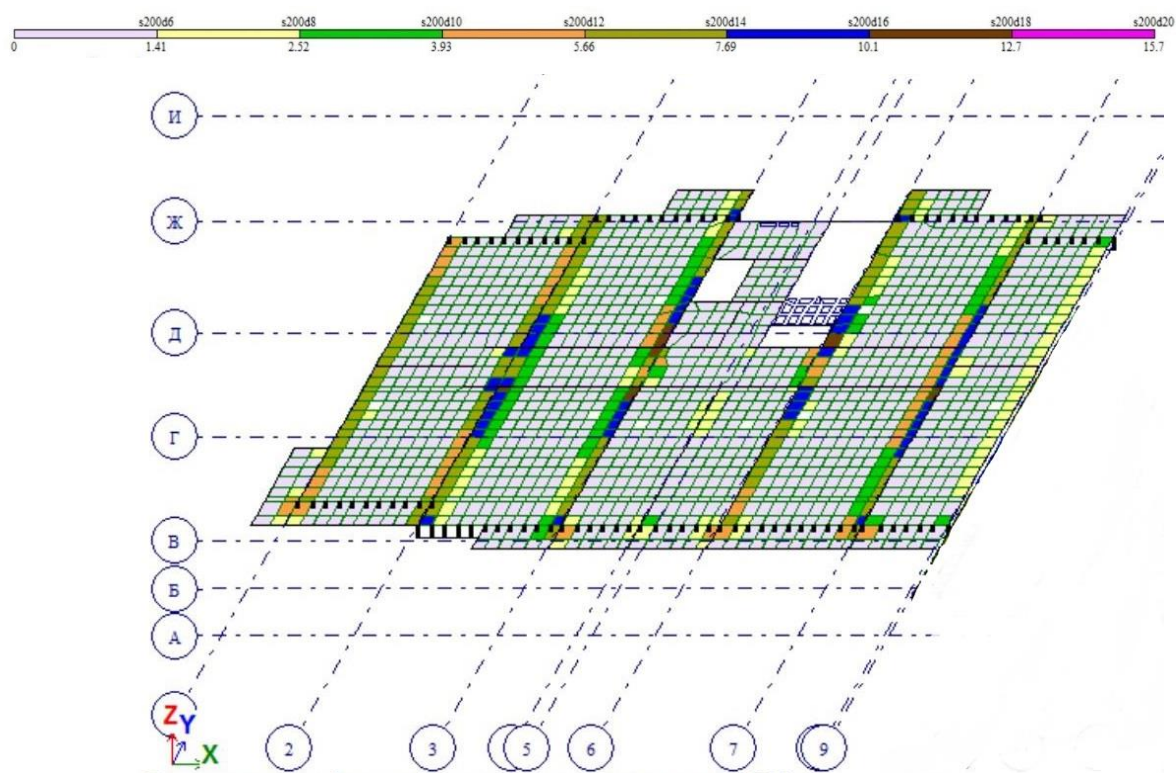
Секция 1. Верхняя арматура в плите перекрытия типового этажа по оси X см²/пм
